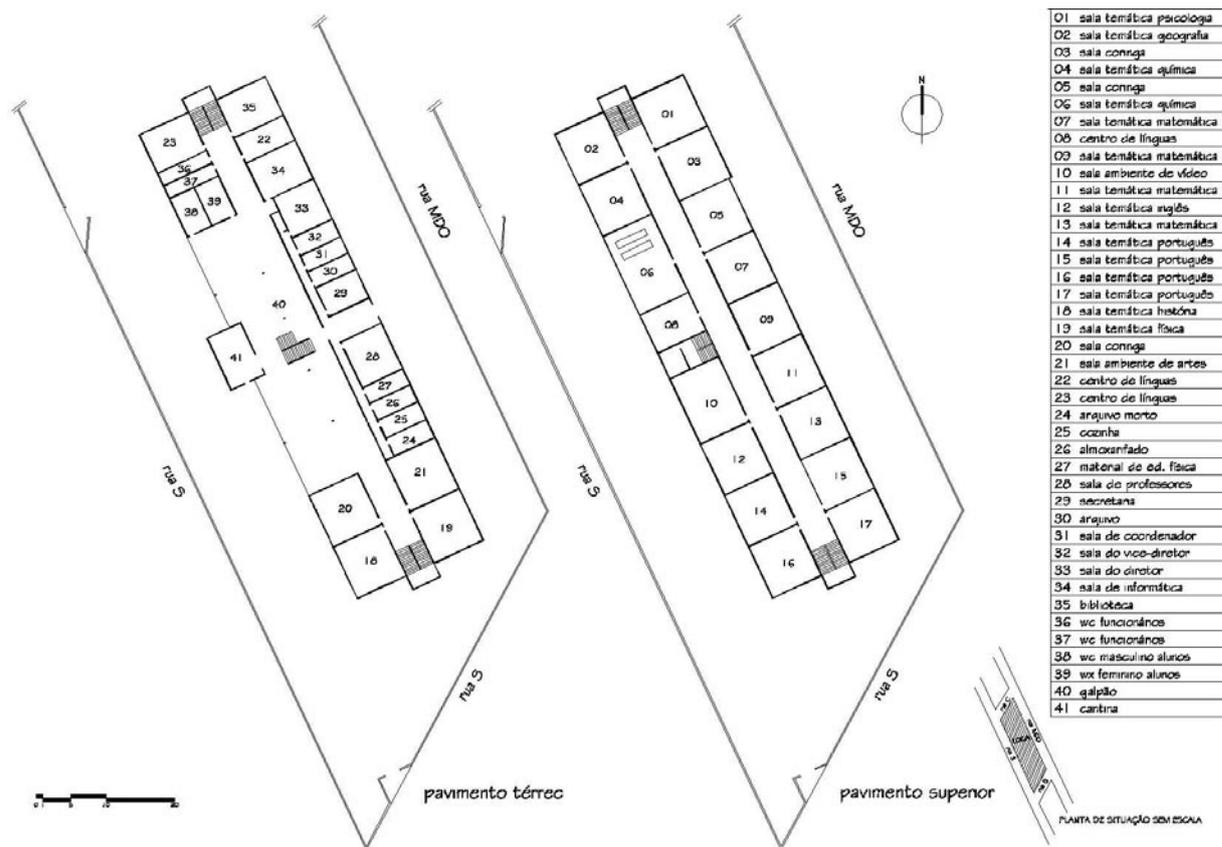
PLANTA CADASTRAL DOS PAVIMENTOS DA ESCOLA C (atualizado em Maio de 2004)
